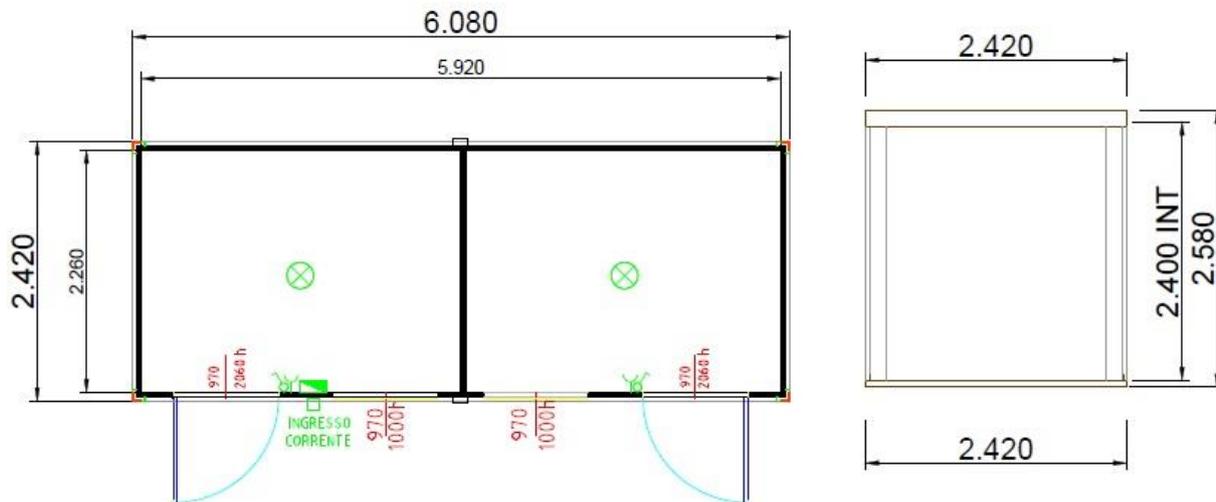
FA04 - Pianta e sezione monoblocco ad uso locali ufficio
